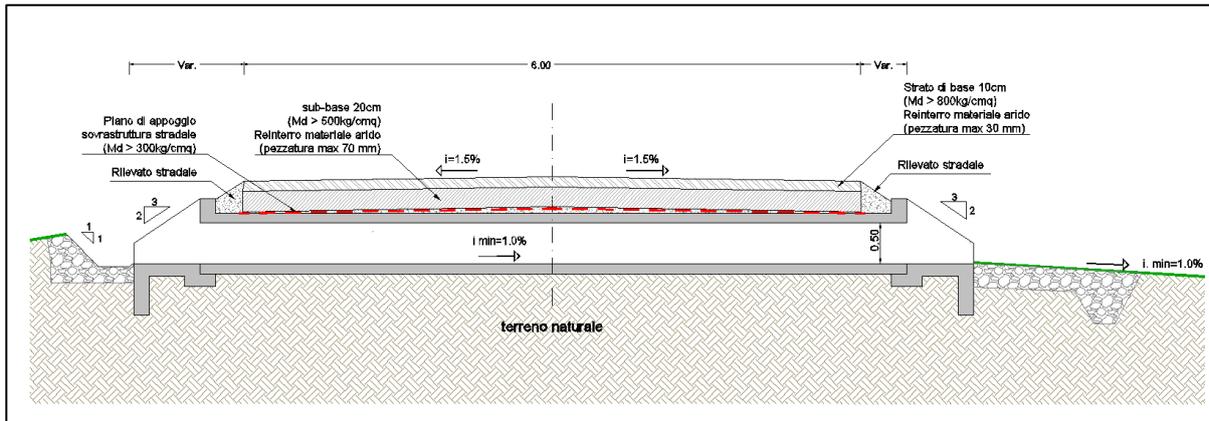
Sezione tipica di sezione stradale con condotta di attraversamento
